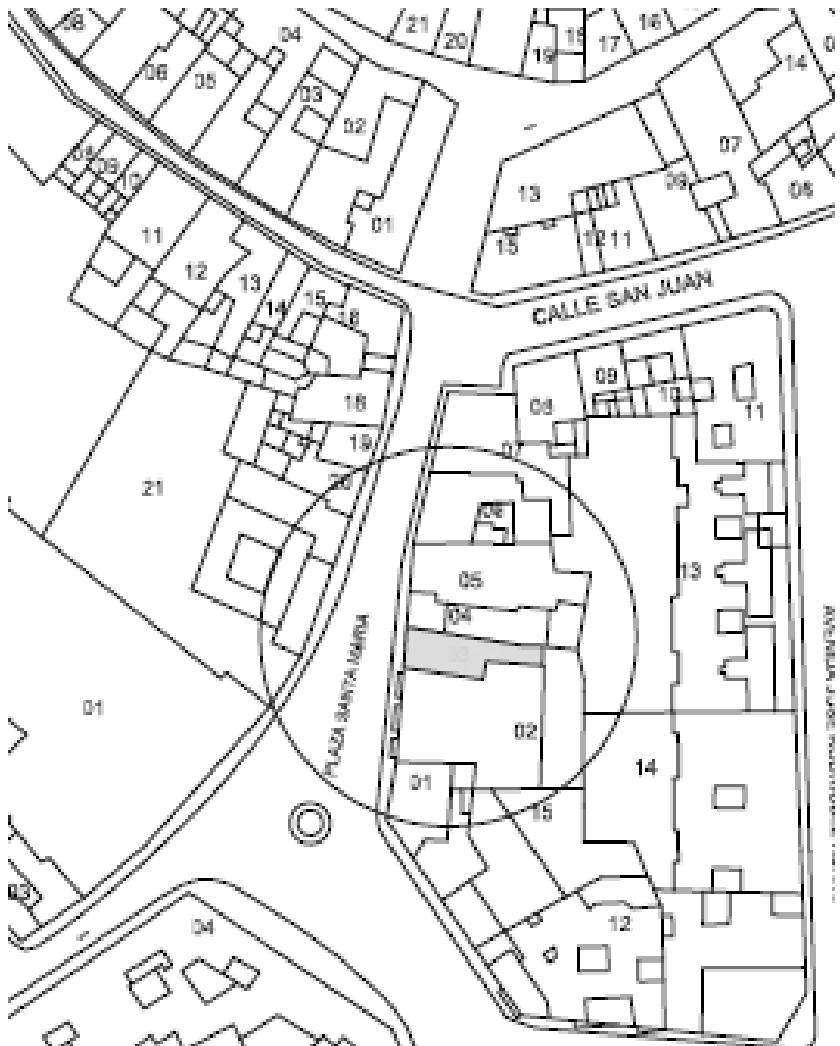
Plano situación. 2017. Fuente: Proyecto Vivienda Unifamiliar situada en plaza Santa María nº 11 de Almansa (Albacete)
